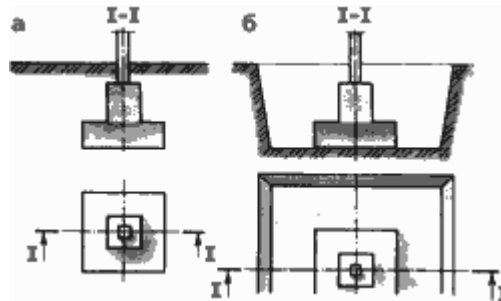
Порядок ремонта и усиления столбчатых фундаментов: а - столбчатый фундамент, требующий усиления; б - рытье котлована вокруг фундамента, подлежащего усилению.
